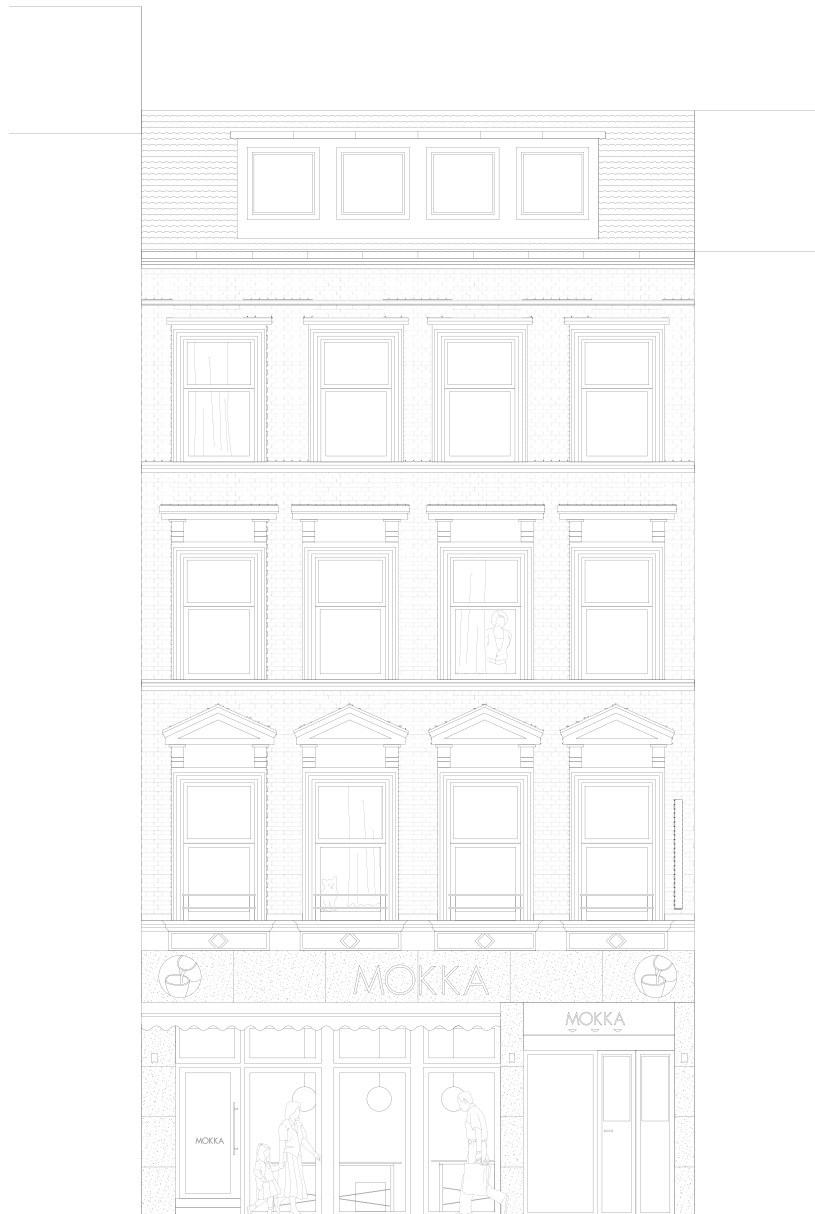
Fassade Elsassstraße 55, ehemals Kennedygrill. Zeichnung: Laura Erdmann.
